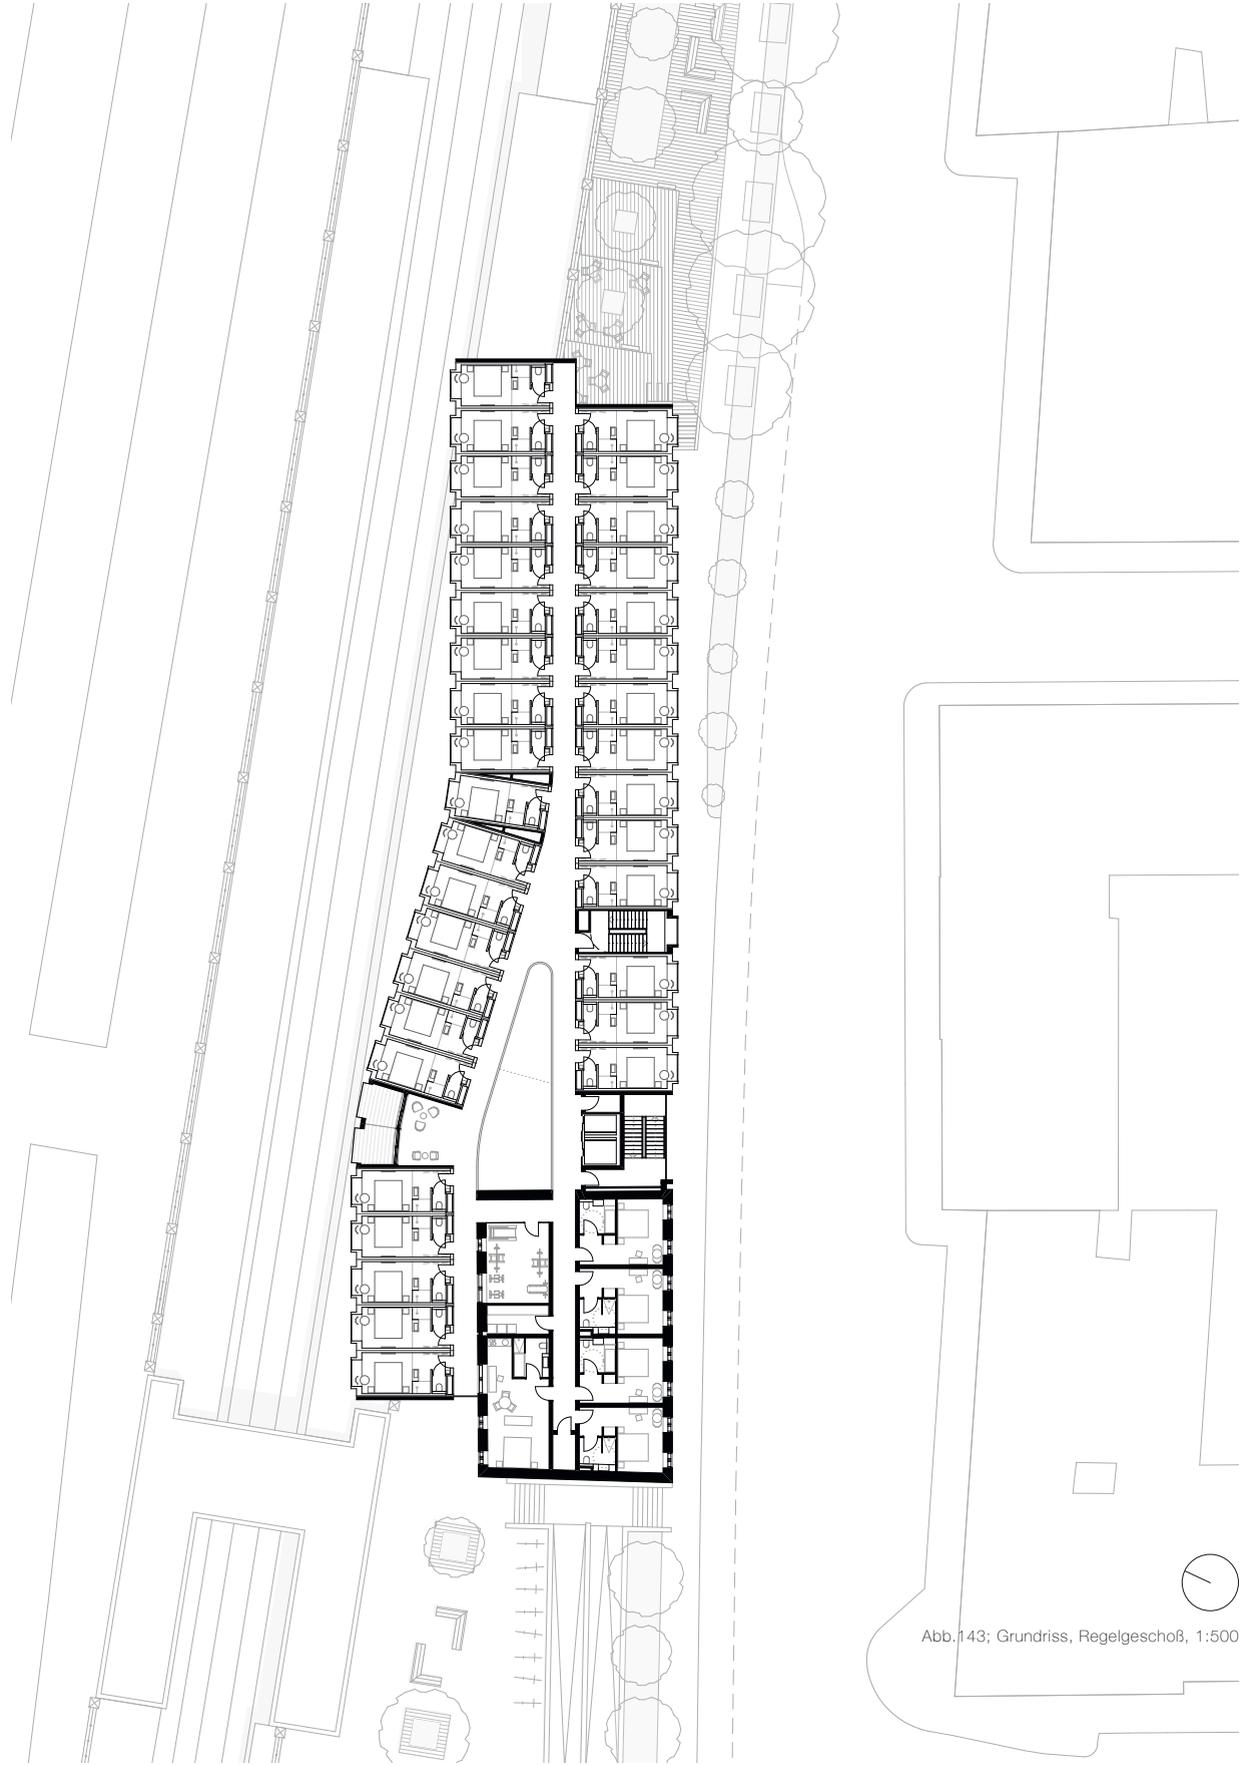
; Grundriss, Regelgeschoß, 1:500
